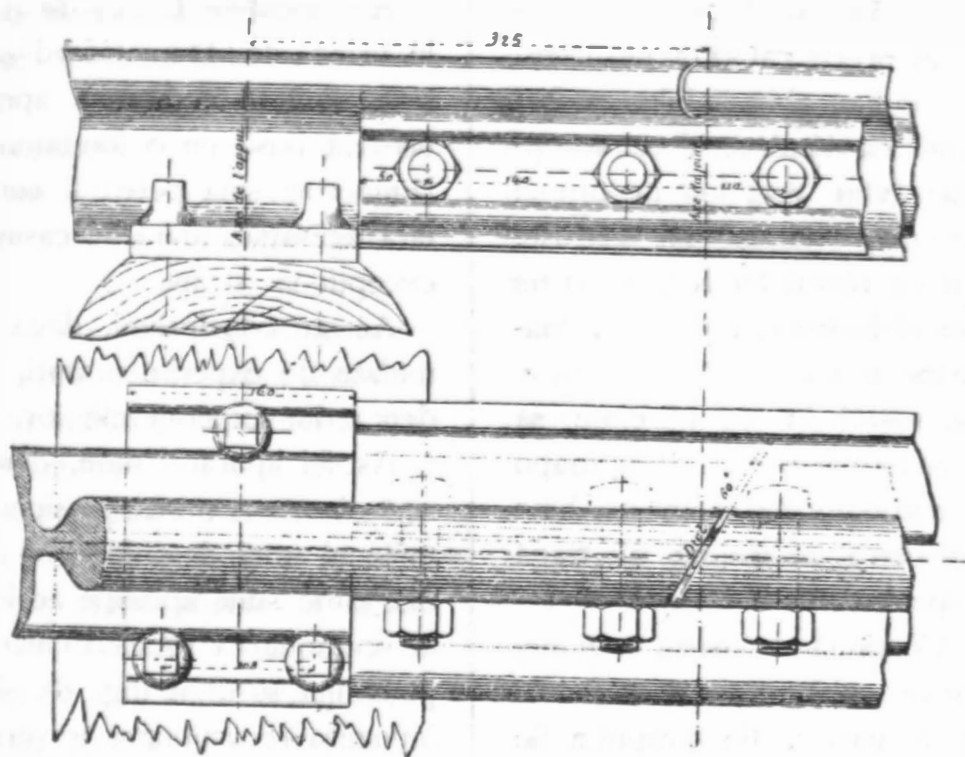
și 3.—Proiect de cale Flamache, 1881. Elevațiune și plan.
